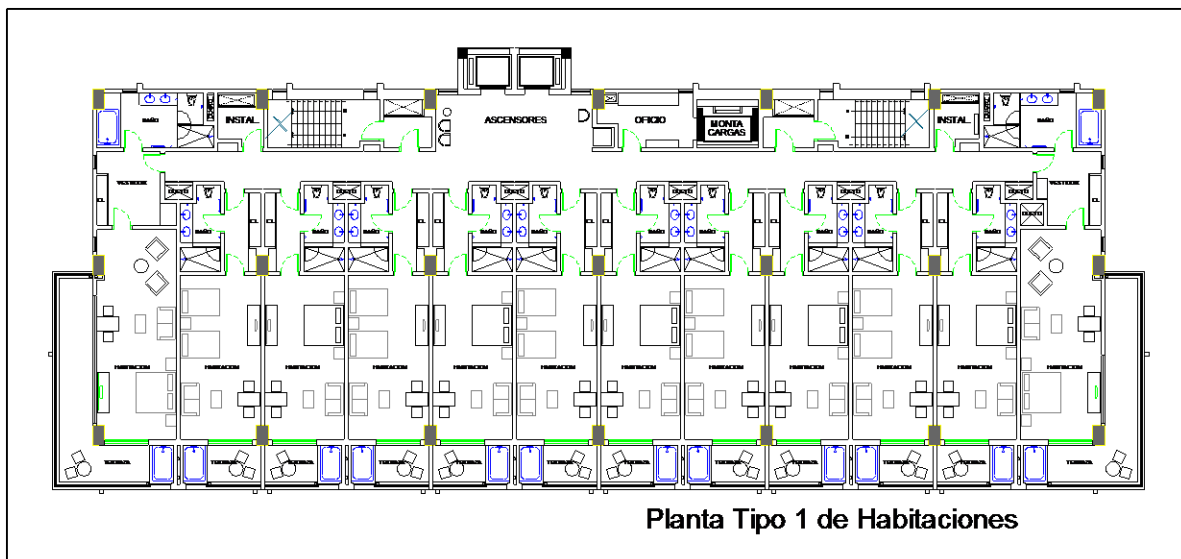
Planta arquitectónica tipo de las habitaciones del edificio Fase 1.
